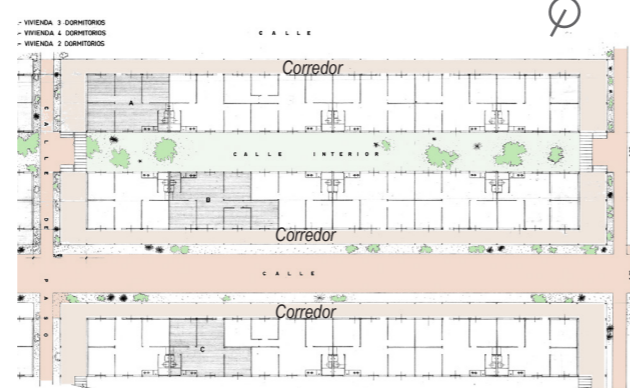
Planta tipo. Imagen con intervención propia.
